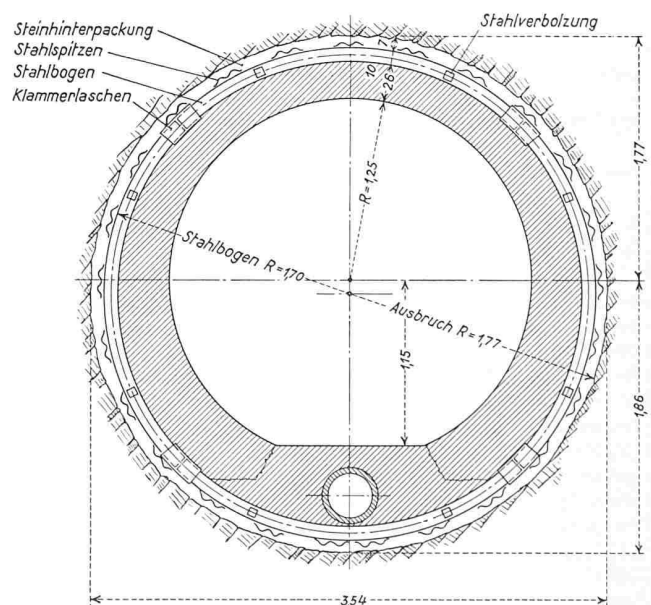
Geschlossener Stahleinbau für stark verformbares Gebirge. Verzug mit Stahlbrettern (Spitzen). Masstab 1 : 50
